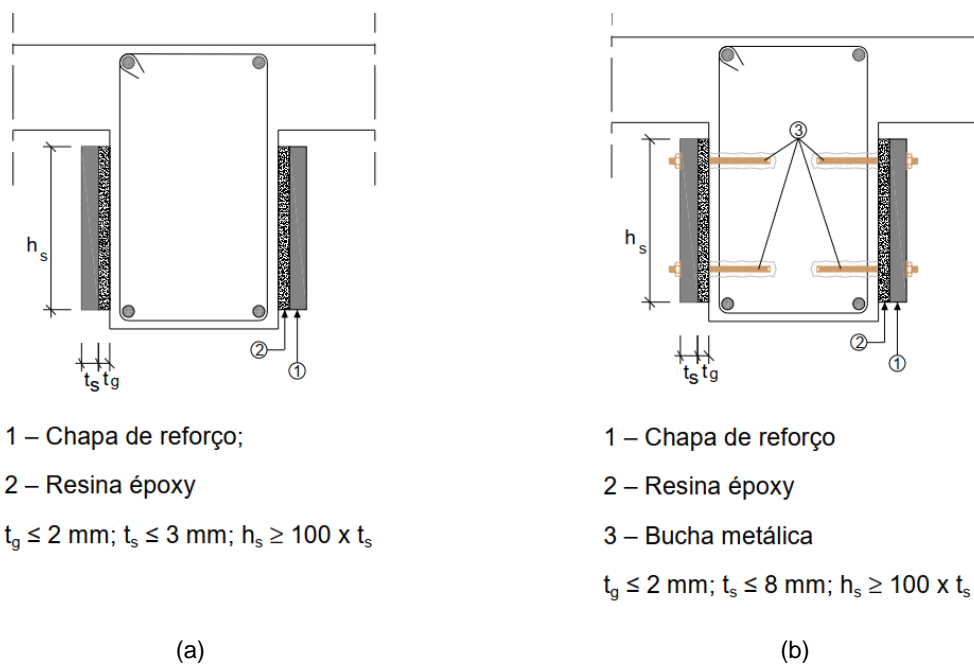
Reforço de vigas ao esforço transversal por colagem de armaduras metálicas sem bucha metálica (a) e com bucha metálica (b) – adaptado de Sousa (2008)
